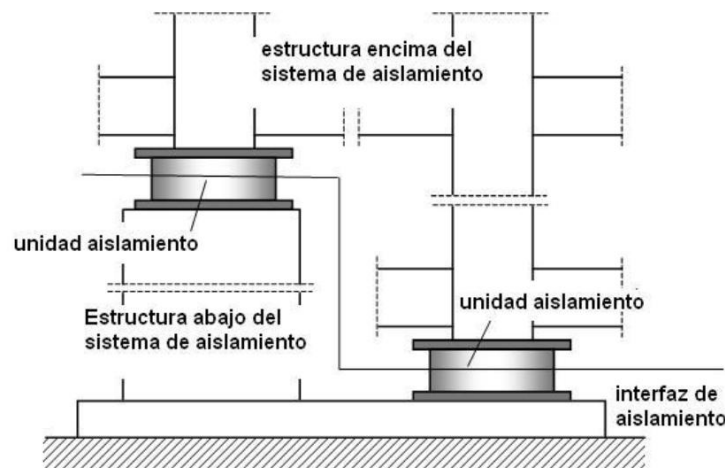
Componentes de un sistema de aislamiento (Meza & Sanchez, 2010).
